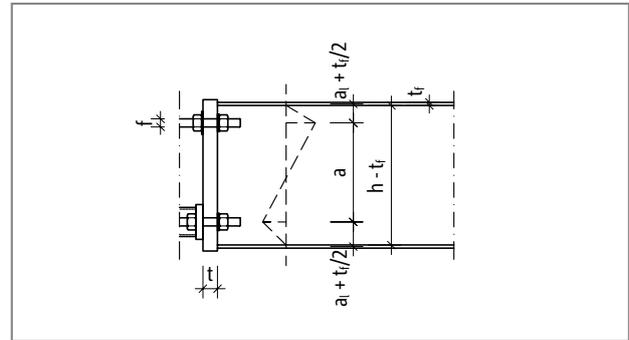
Plaque frontale affleurante T type S : calcul des entrées géométriques ; coupe
